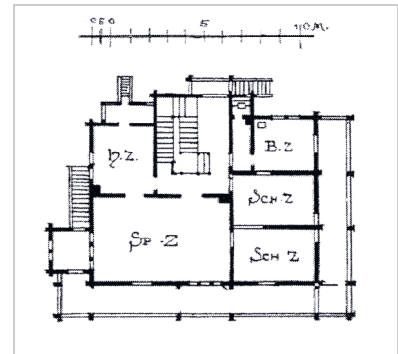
Grundriss des Hauptgeschoßes der Villa Carola.
